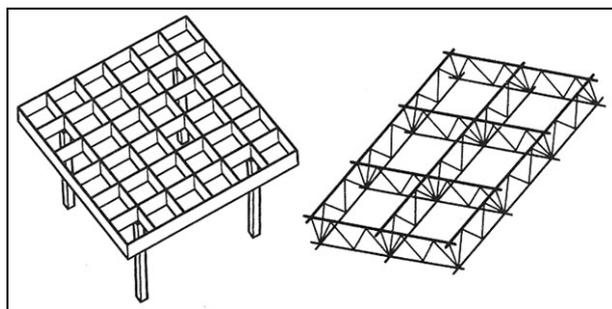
Схемы сплошнотенчатой и решетчатой несущей конструкции покрытия
